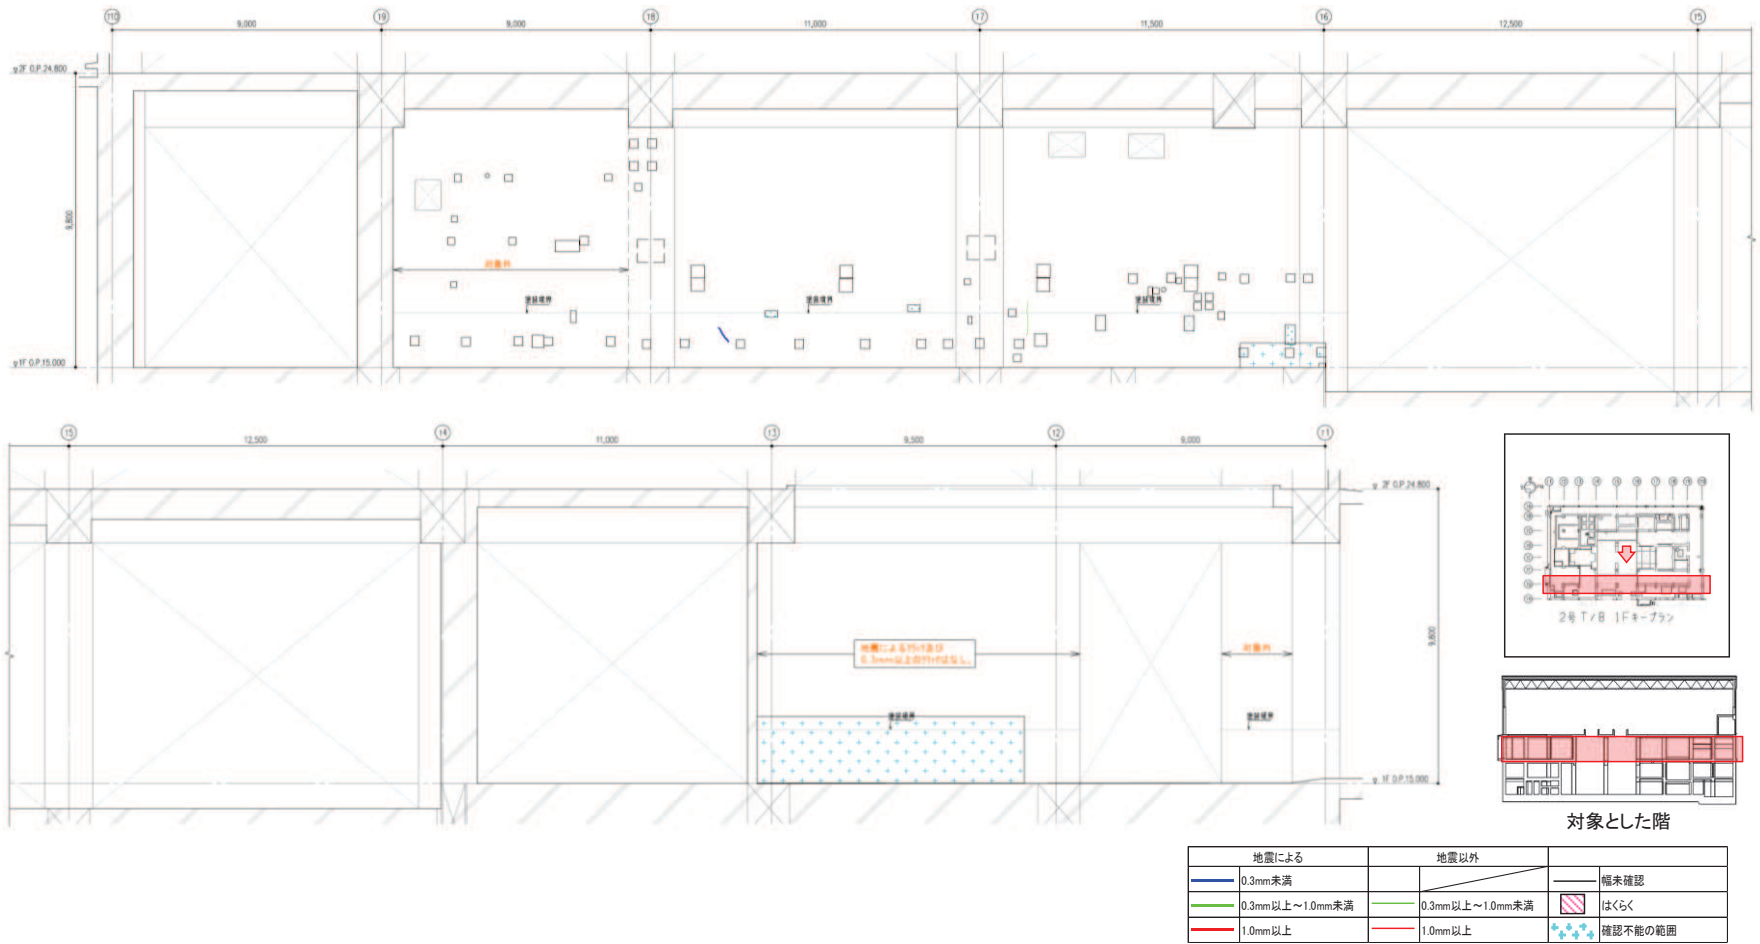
タービン建屋のひび割れ分布 耐震壁 (47) 1階 TG 通り
